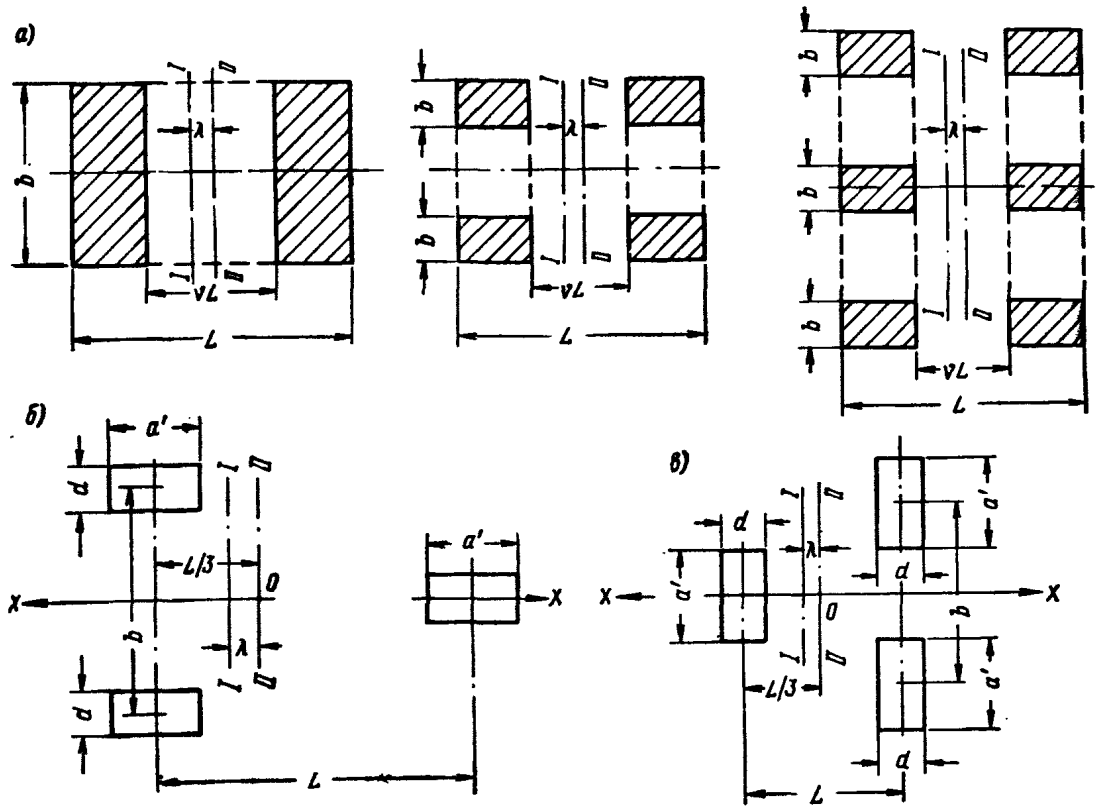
Планы фундаментов в виде отдельных опор. Моментная нагрузка передается на фундамент в направлении горизонтальной центральной оси
